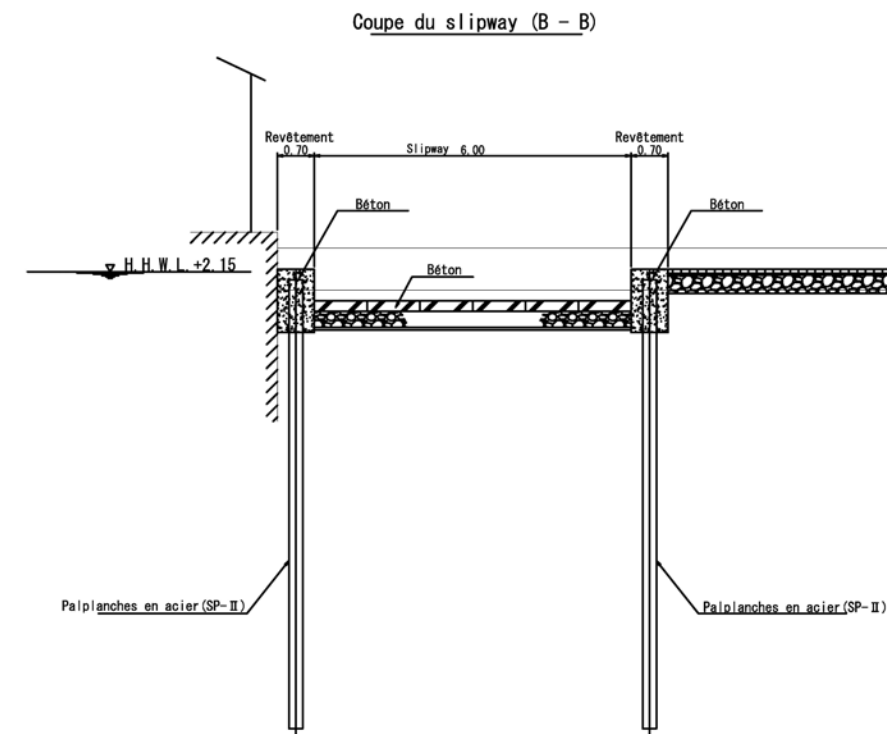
Revêtement à palplanches verticales / slipway Coupe s : 1/200
